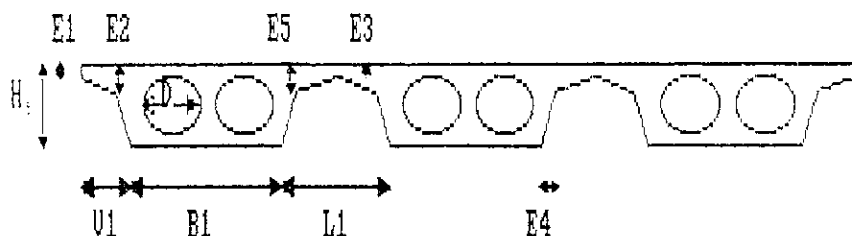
Sección transversal de un tablero losa plurinervado (Tipo 2).
